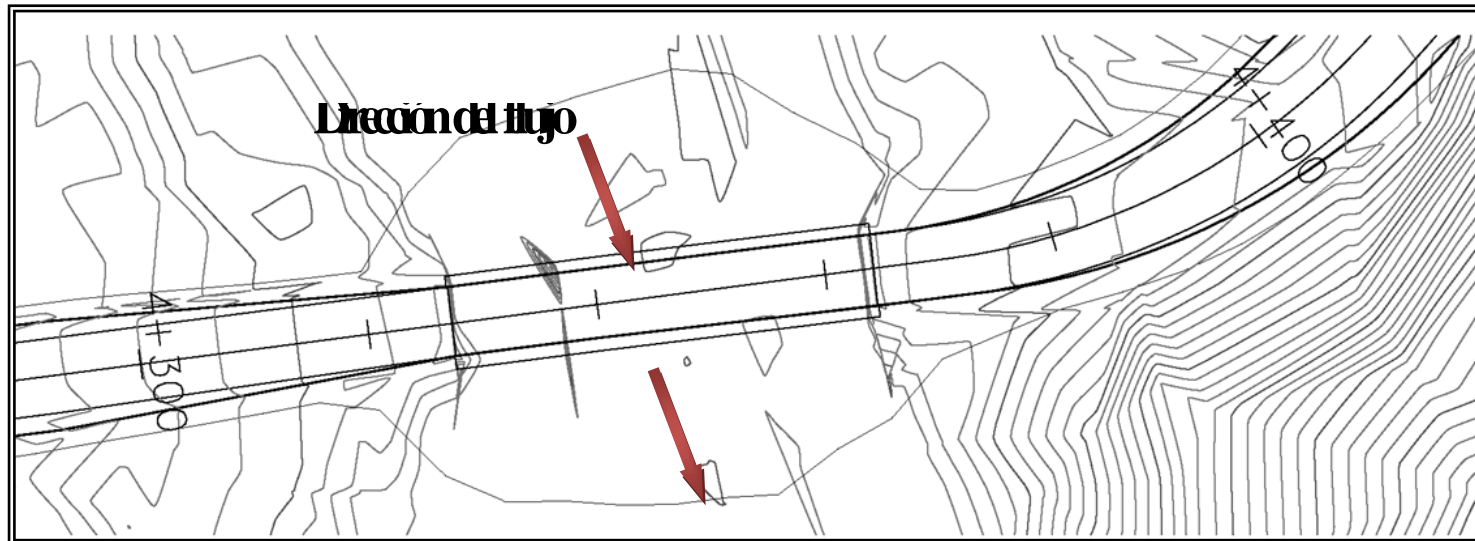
4 Características genéricas y técnicas del tramo de carretera que enlaza el puente. Ver plano completo en Anexos
